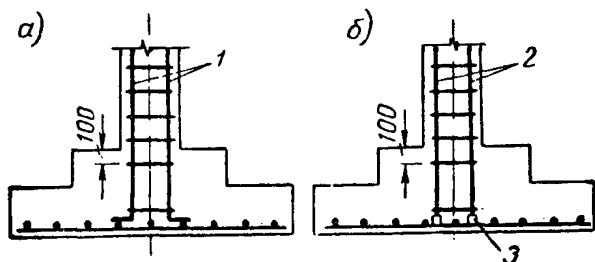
Установка арматуры колонны на нижнюю сетку фундамента
